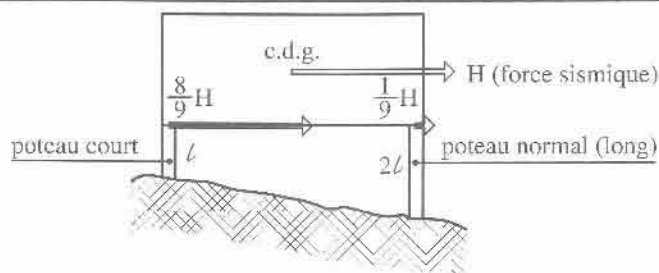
Transfert des efforts d'un poteau normal (long) vers un poteau court
